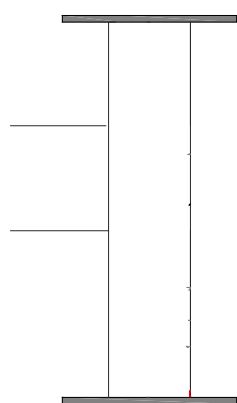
(c) ひび割れ状況 (試験体 F3)
